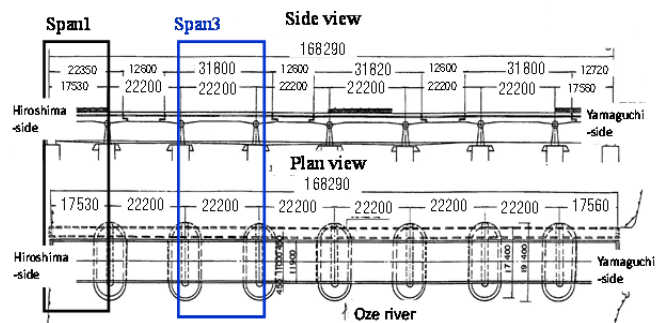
「SK橋」側面図および平面図(撤去前)と調査区間
